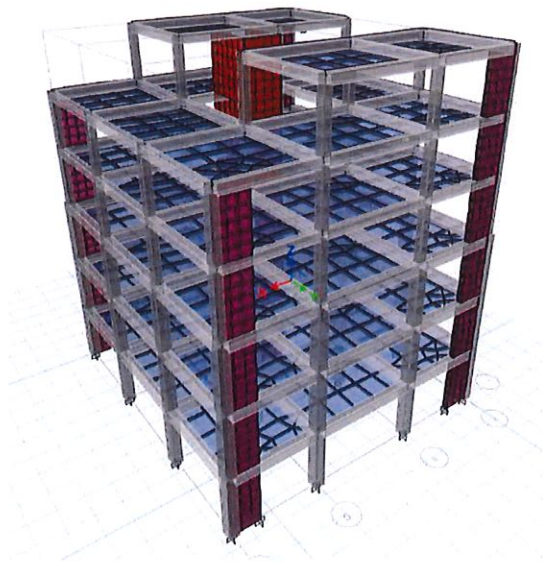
Modelado del sistema estructural de hormigón armado que incluye muros estructurales
